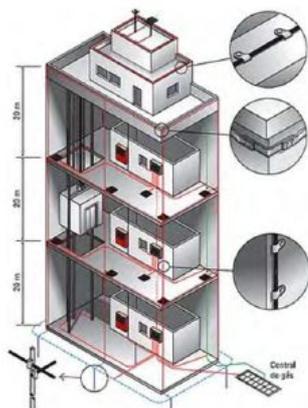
Detalhes das amarrações entre RE-BAR e ferragens verticais, com ferragens horizontais
